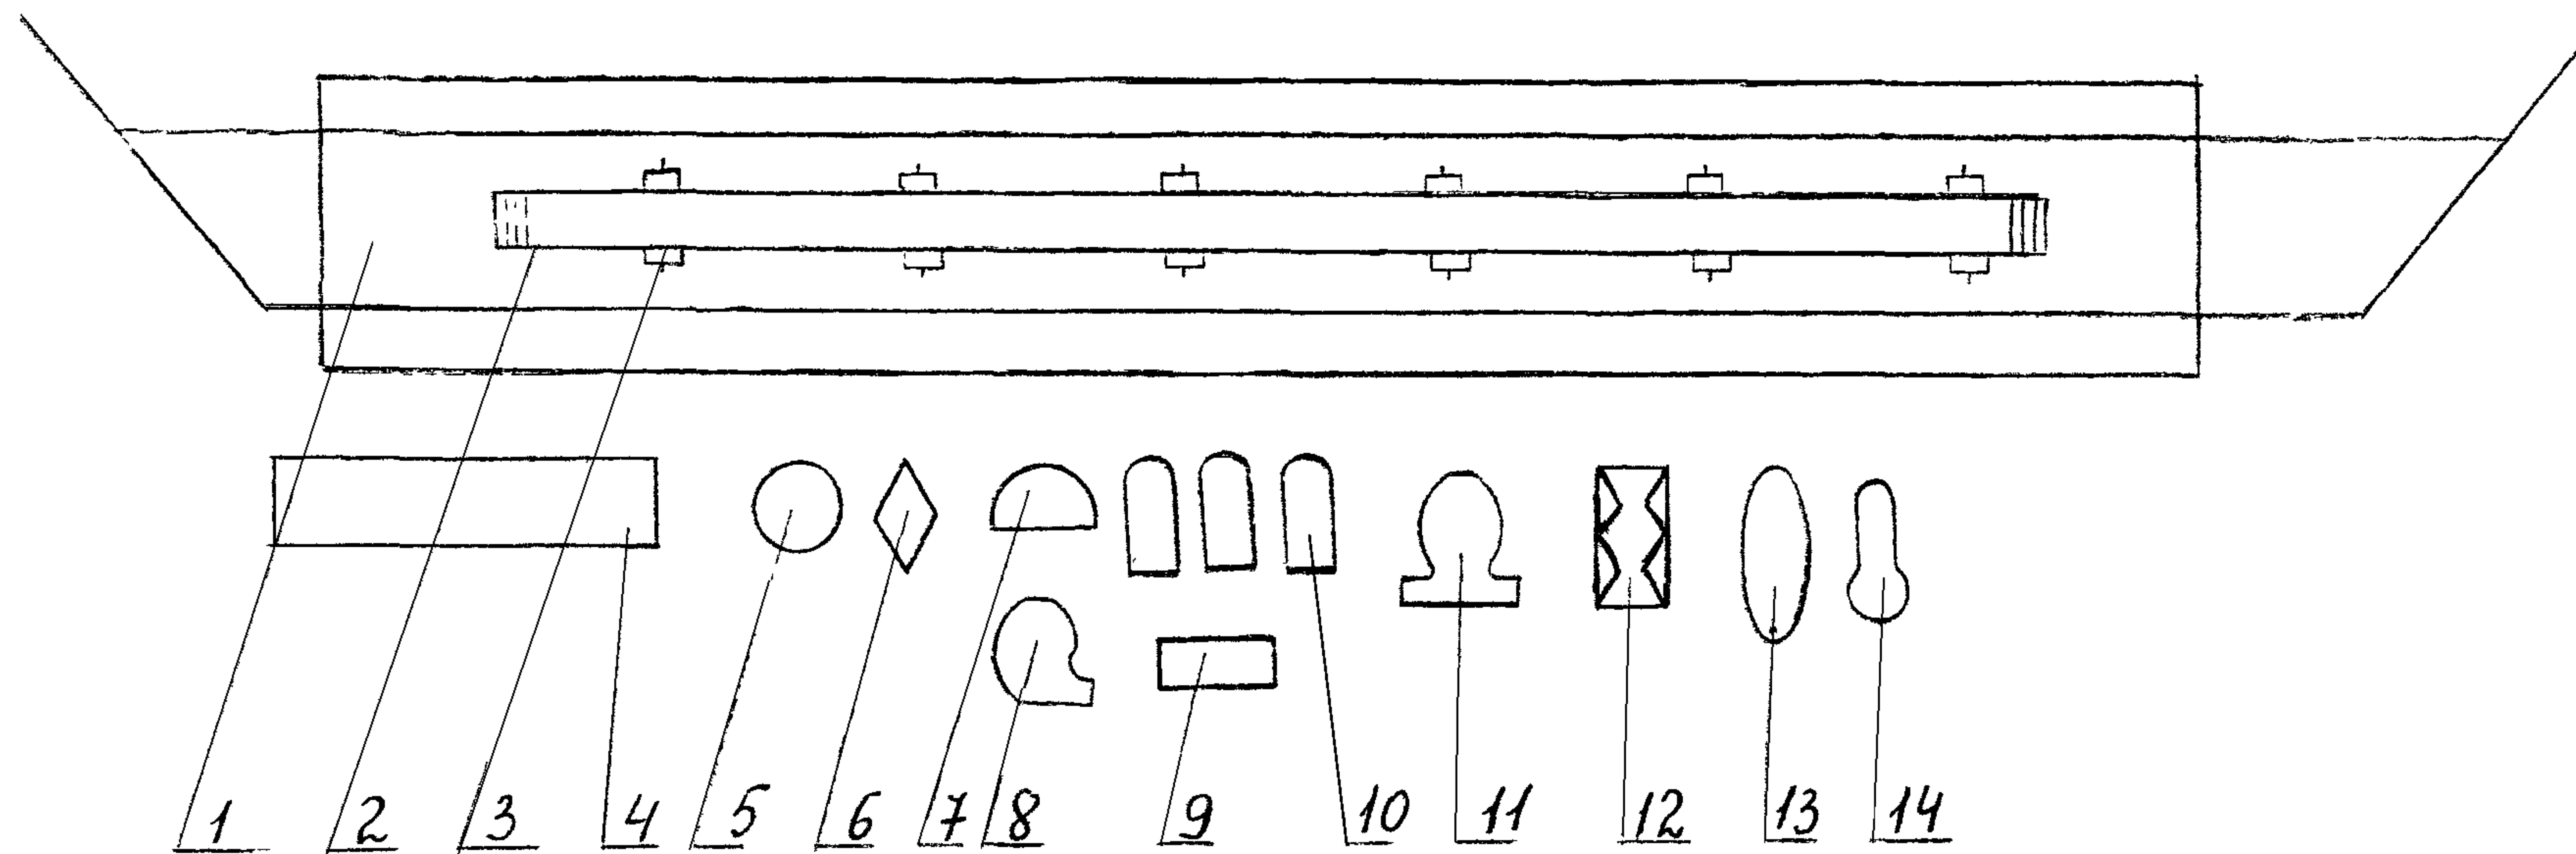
Рис. I. СХЕМА ПЛОЩАДКИ ОБРАБОТКИ ЦИСТЕРН ИЗ-ПОД ЭТИЛИРОВАННОГО БЕНЗИНА НА ППС.
